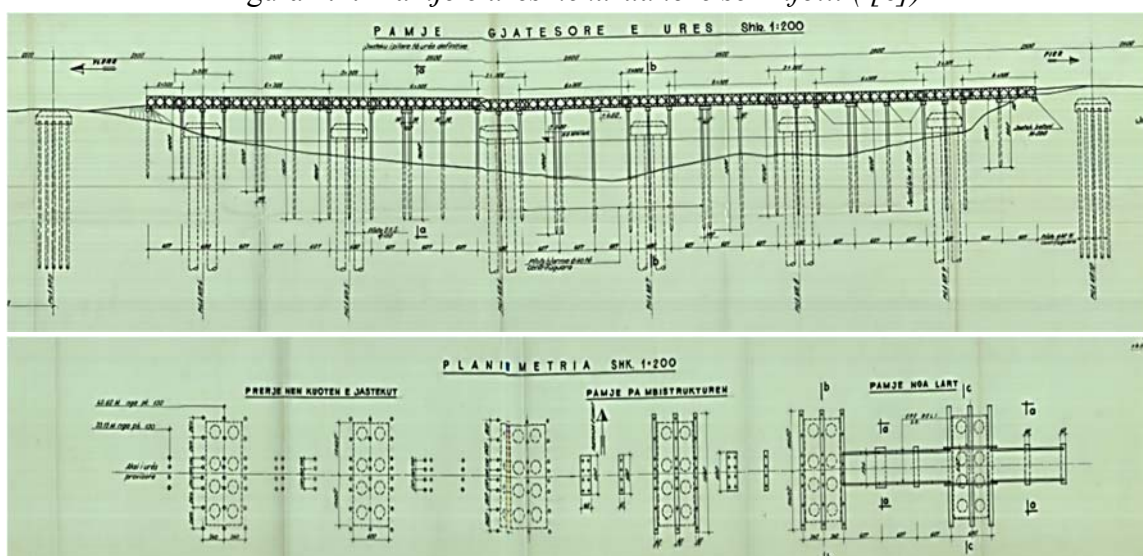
Planimetria e urës hekurudhore të Mifolit ([6])
